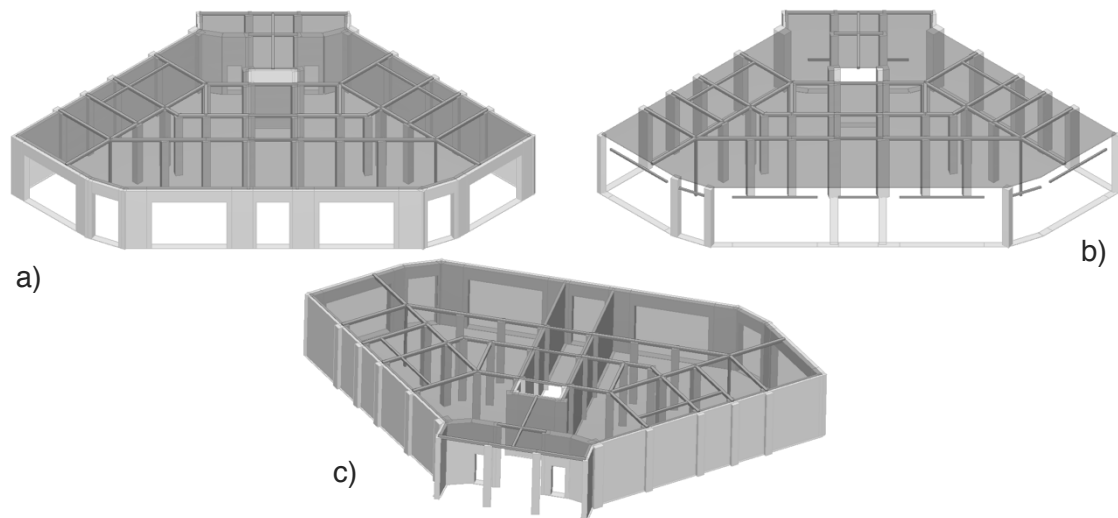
Modelo Tremuri edificio ED-04 planta baja. a) Vista isométrica fachada principal. b) Vista isométrica fachada principal sin muros. c) Vista isométrica fachada trasera
